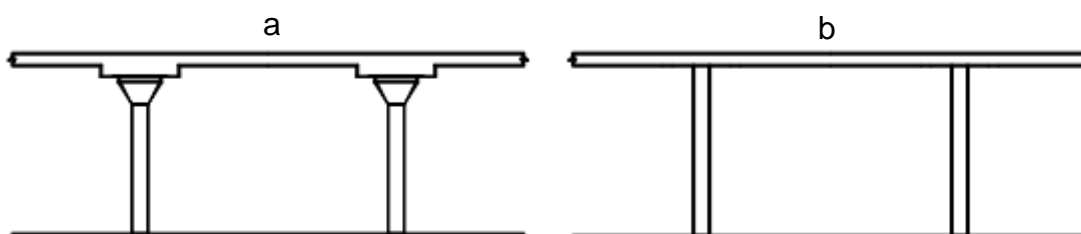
a) Sistema em laje-cogumelo. b) Sistema em laje lisa.
